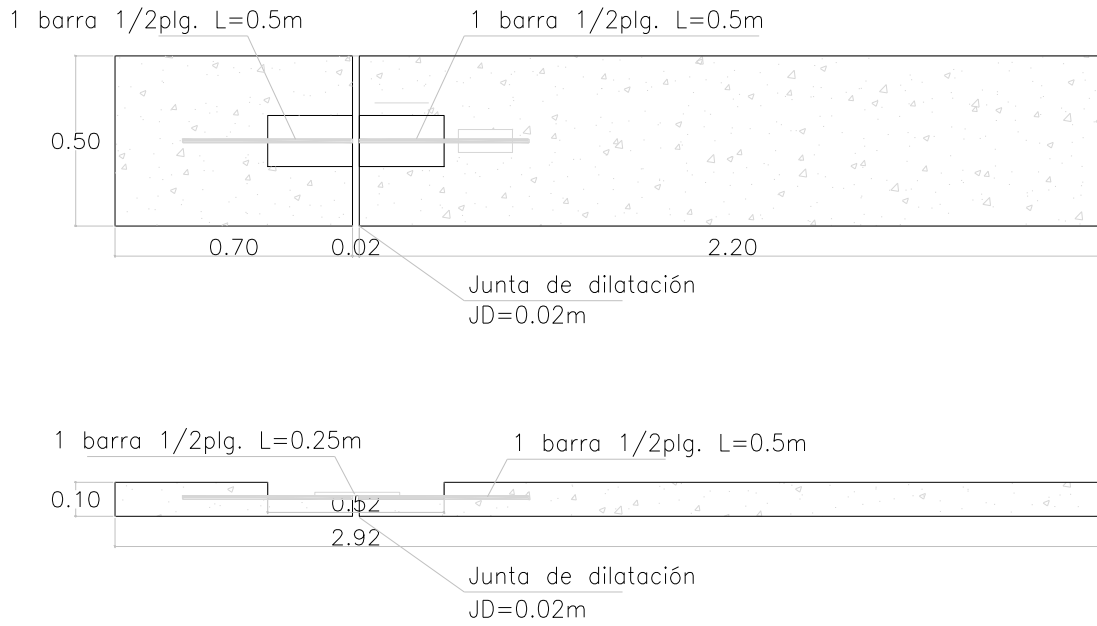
Esquema de unión de barras de refuerzo en la conexión.
